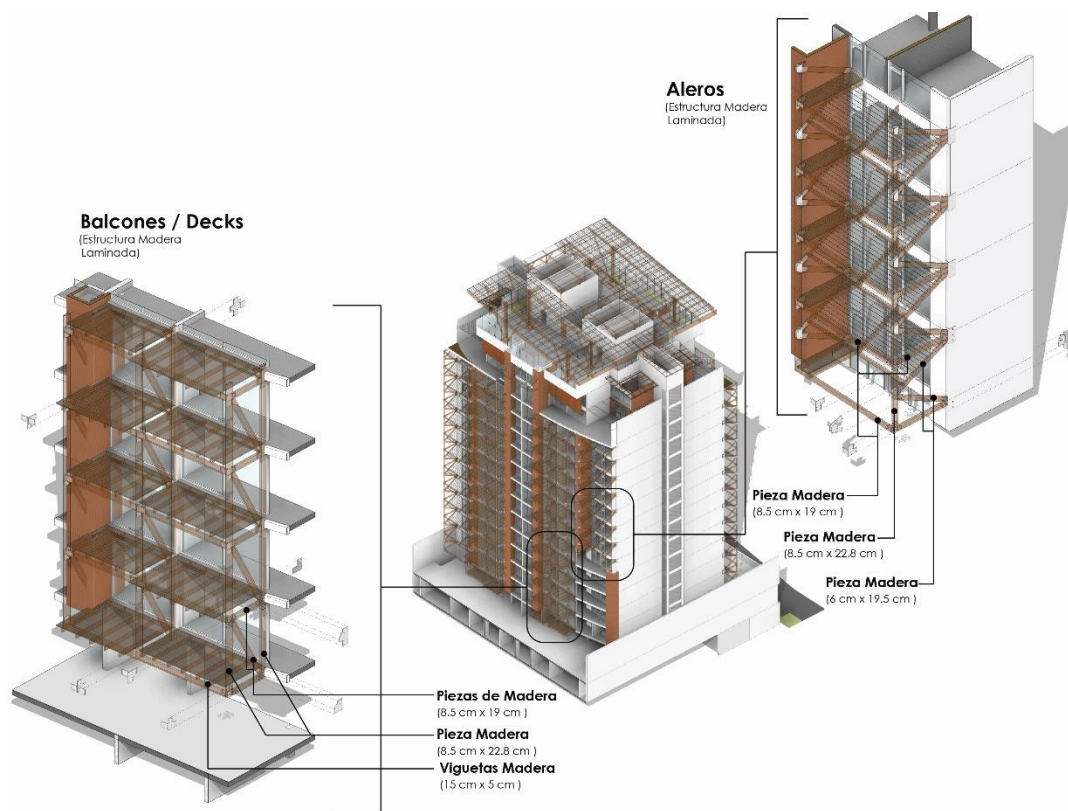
Detalle y especificaciones de la estructura en madera laminada. Fuente: Elaboración propia
